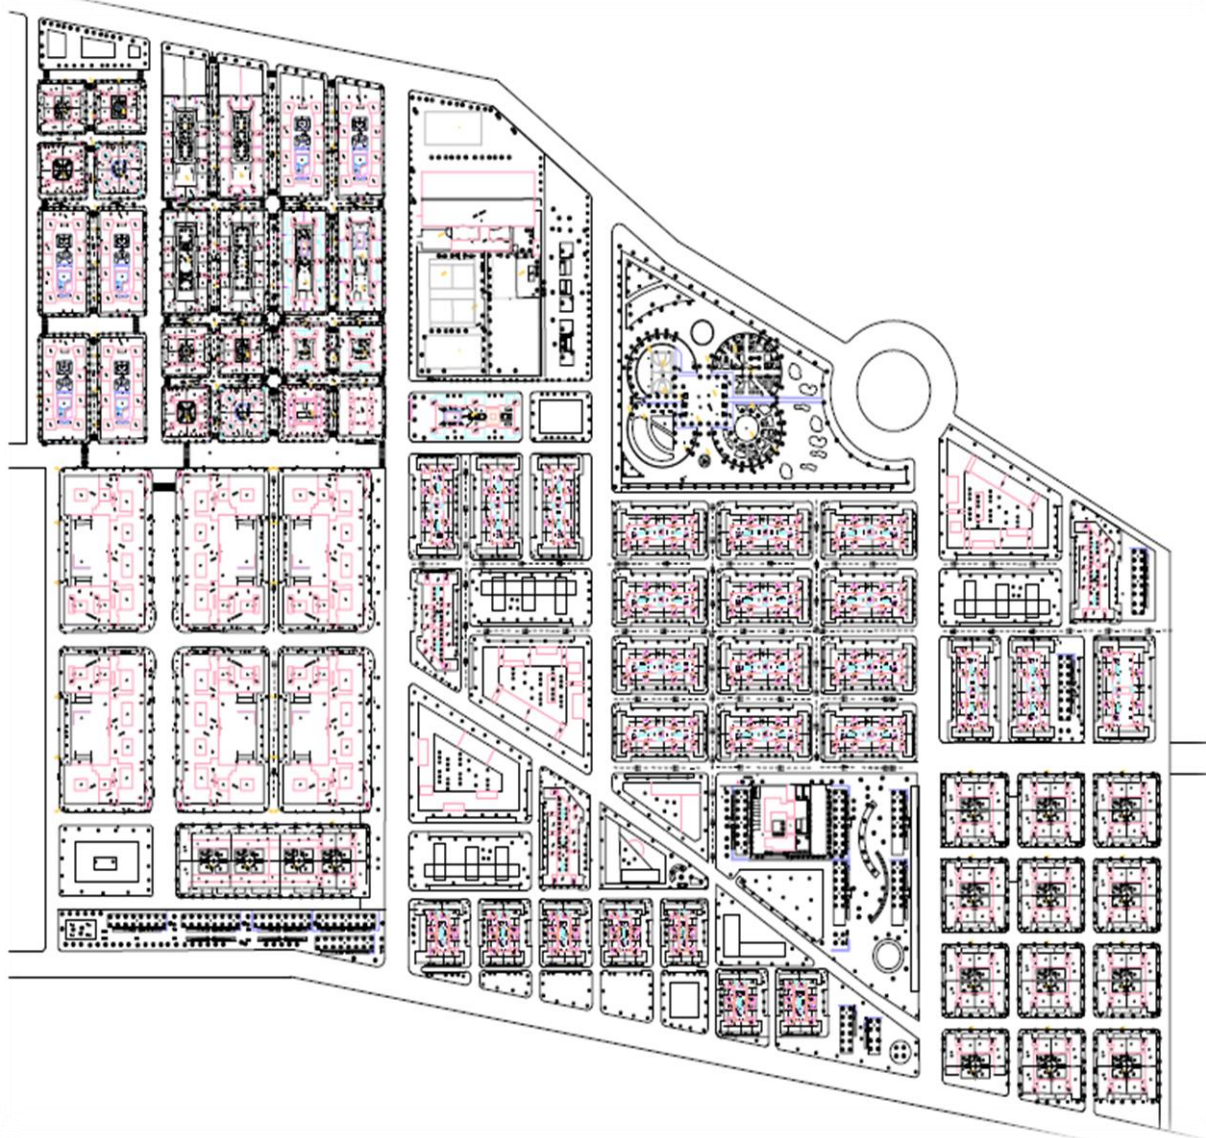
Planificación arquitectónica de la reconstrucción de la zona destruida
